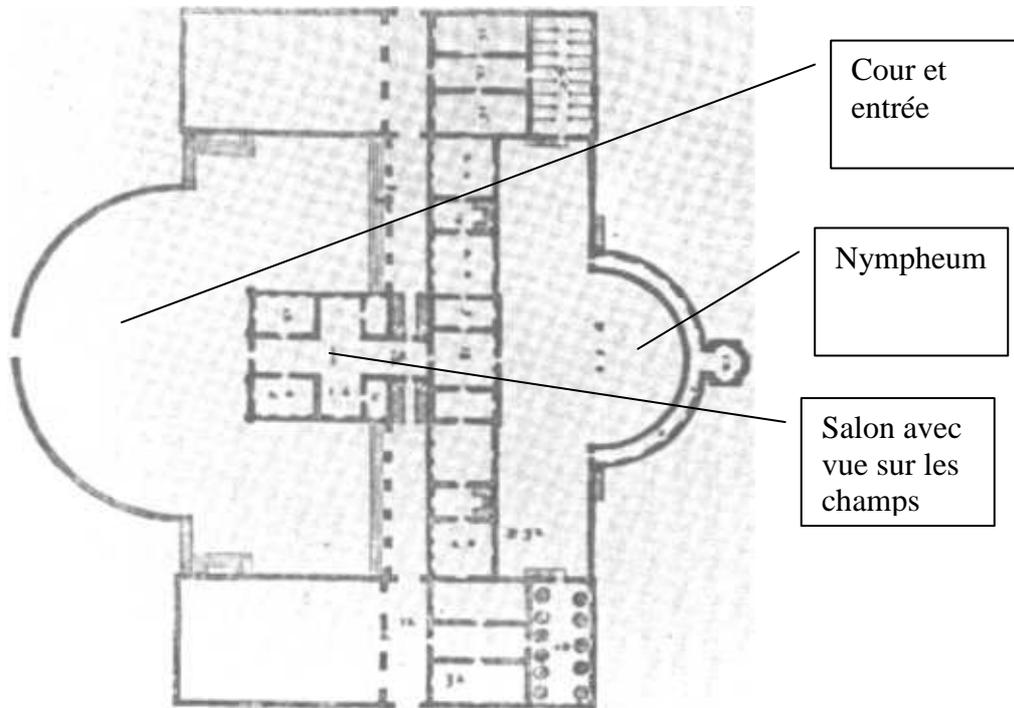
Le plan de Villa Barbaro construite par Palladio (vers 1550)
